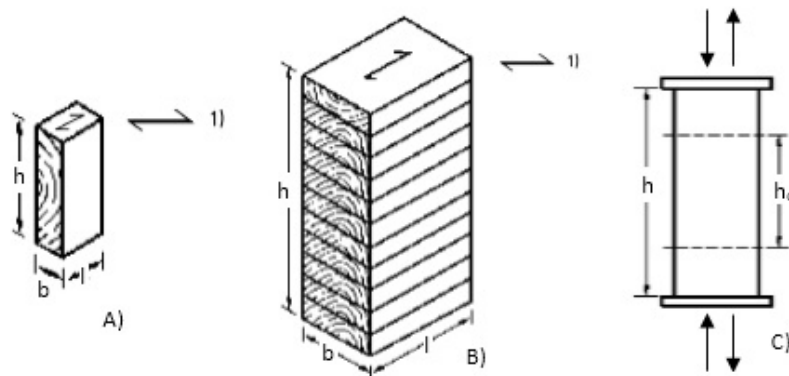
Disposición de elementos: A) madera aserrada, B) laminada encolada y C) fundamento del ensayo.
